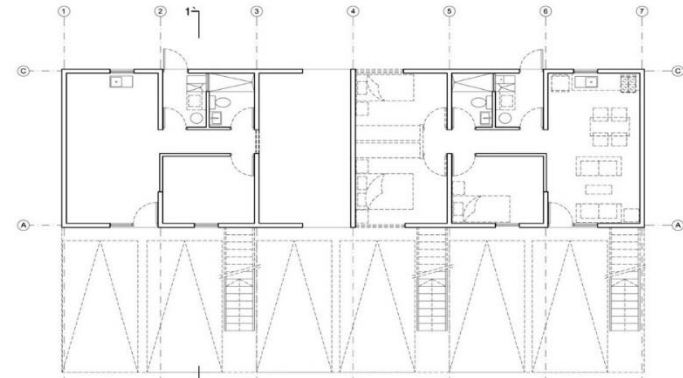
Planta Arquitectónica apartamento primer nivel
